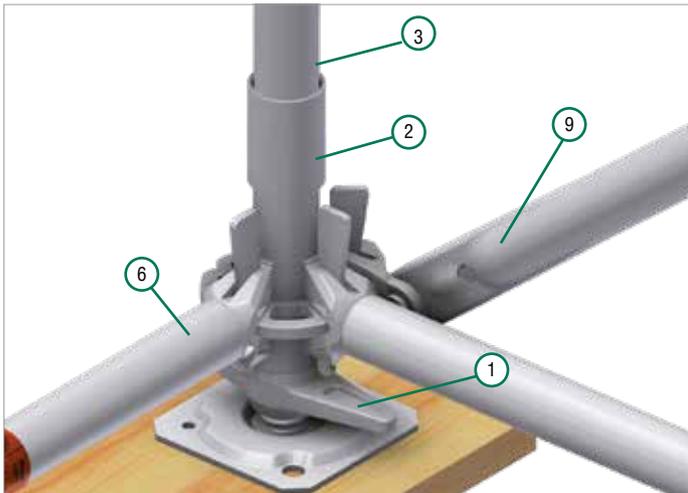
Detail Gerüstknoten mit Anfangsstück und Spindel
